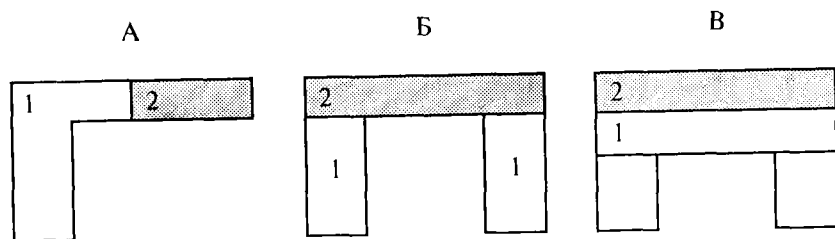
Схемы пристроек к зданиям и встроек
